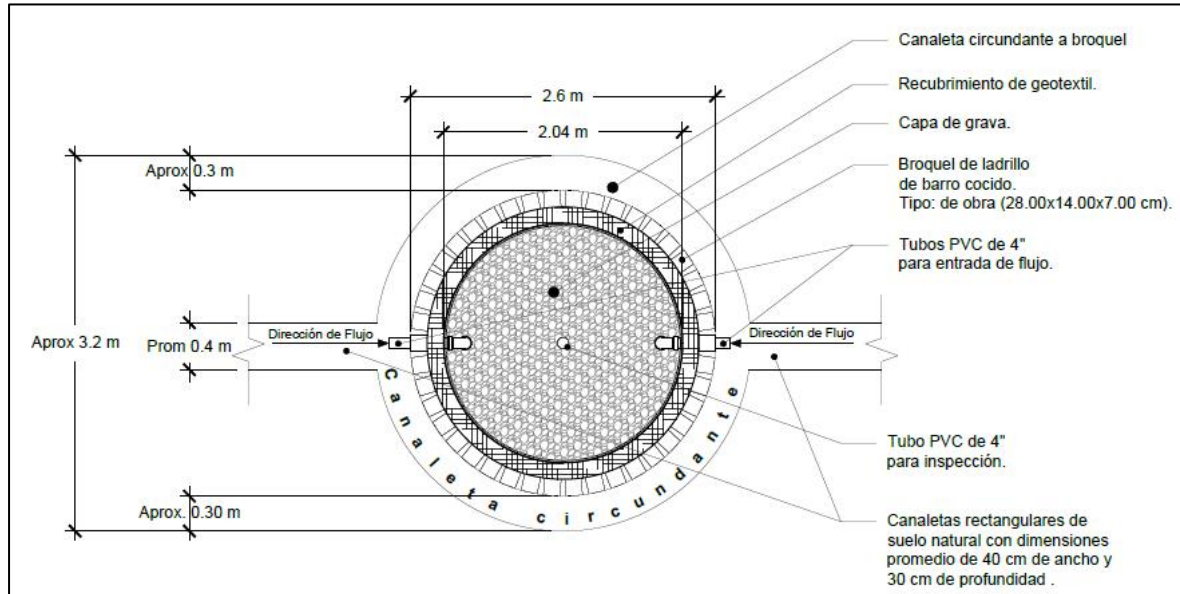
Vista en planta de pozo 4. [Elaboración propia].
